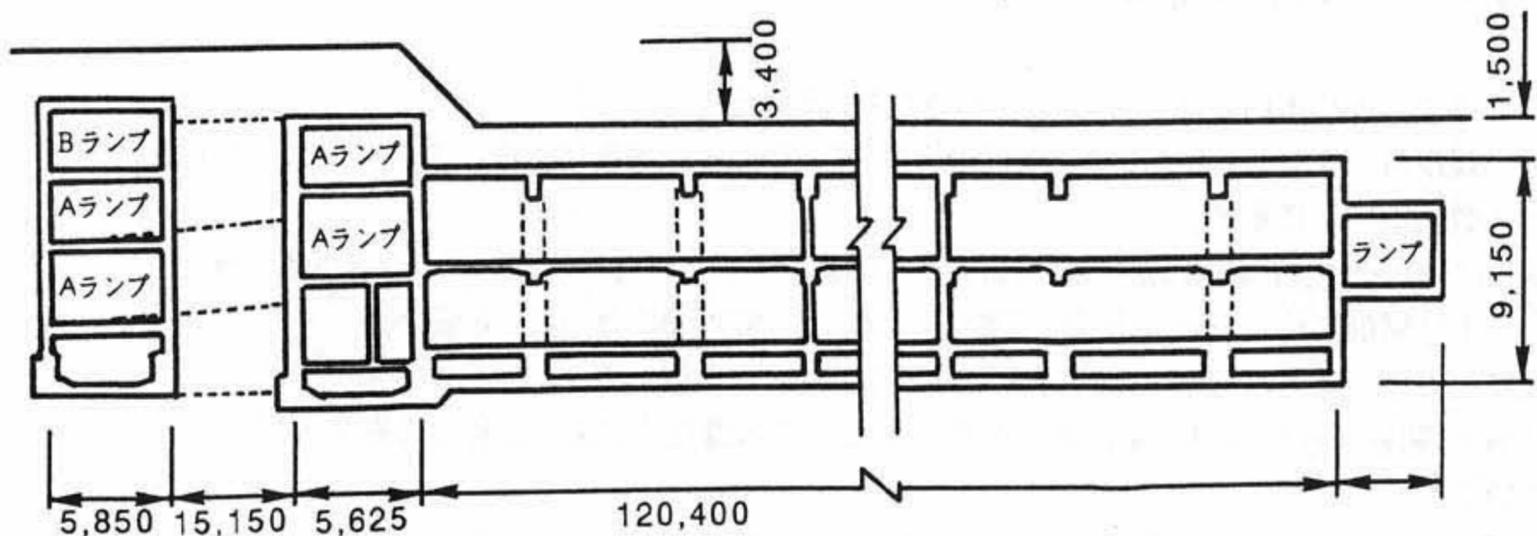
三宮第2駐車場の断面図 (A-A断面)
